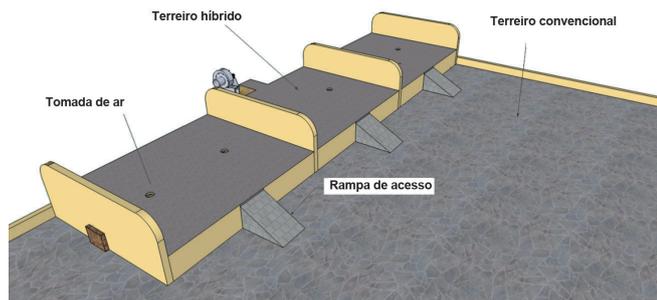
Detalhes do terreiro pronto para receber fôrnelha e telhado.
